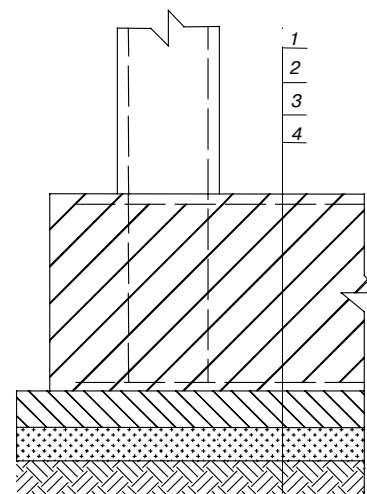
Сплошной барьер (фундаментная плита): 1 – монолитный железобетон; 2 – подготовка из тощего бетона; 3 – песчаная подсыпка; 4 – уплотненный грунт
